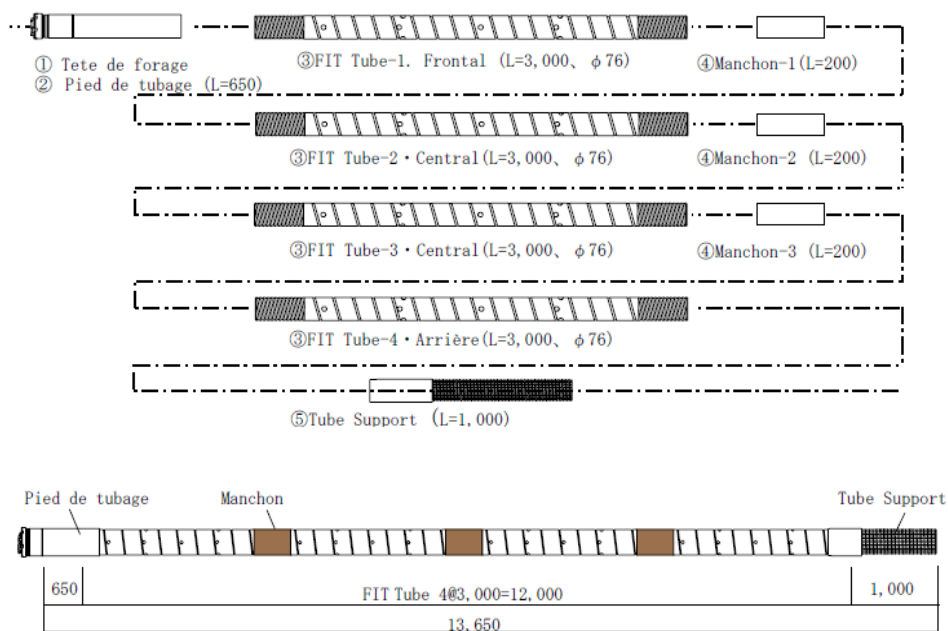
Assemblage des tubes « GFRP », L=13.650 m.
